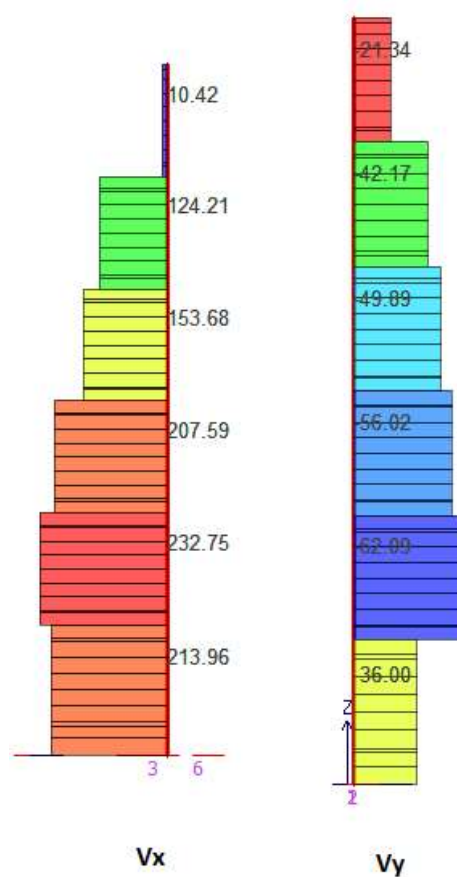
Taglio combinazione sismica più gravosa agente sulla pilastrata – fili fissi con fondazione
